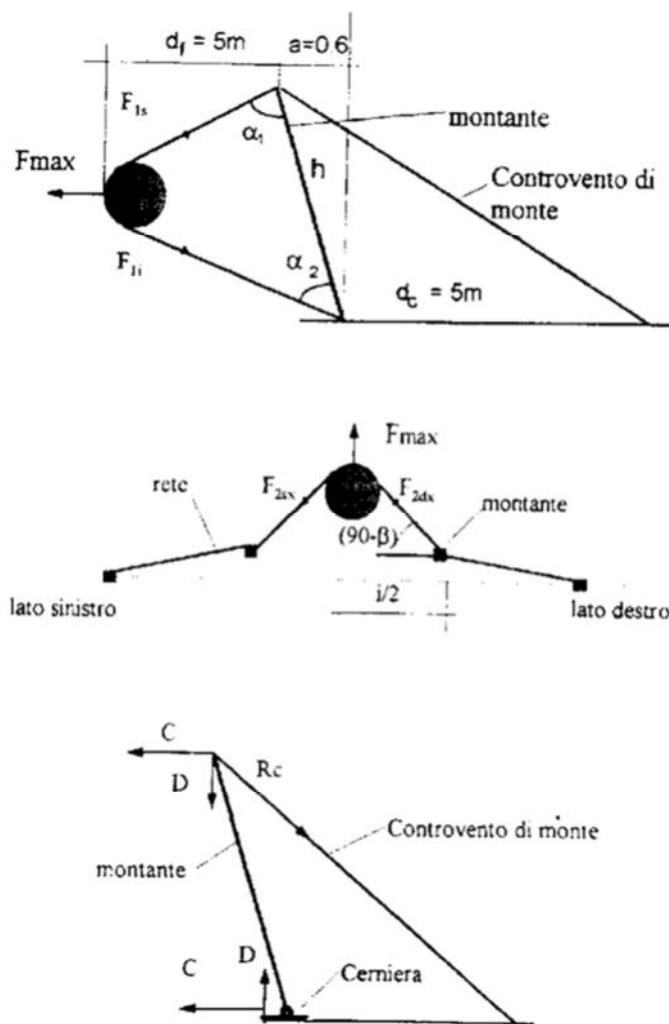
Schema adottato per il calcolo delle barriere verticali: in alto la sezione trasversale, al centro la pianta, in basso le forze agenti sul controvento maggiormente sollecitato (Peila, 1996)
